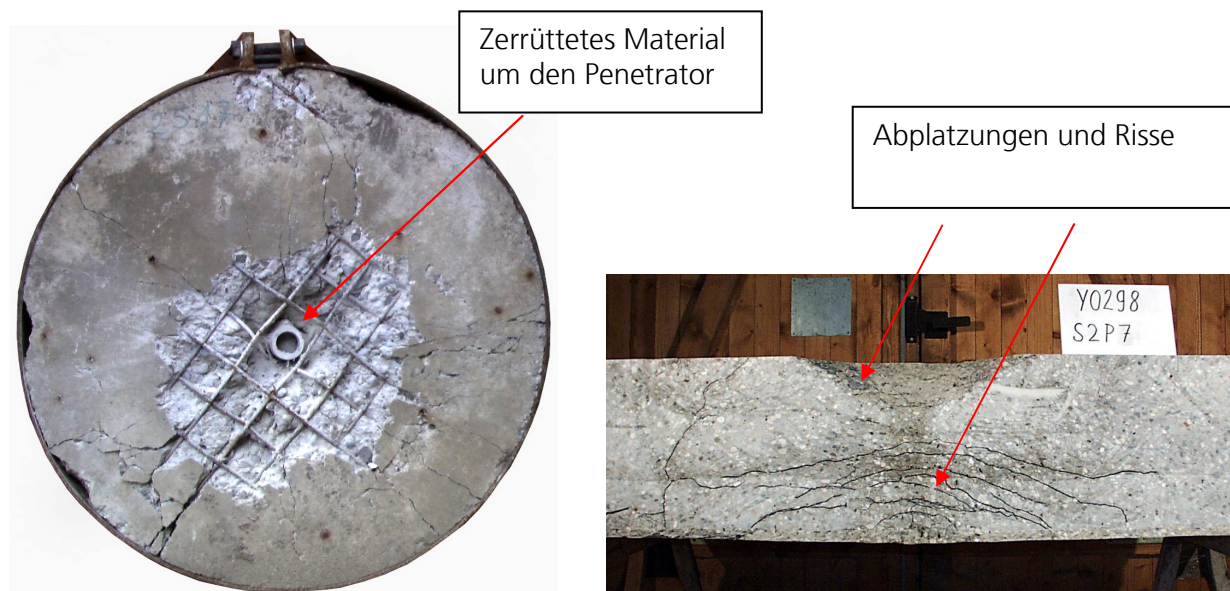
a) Beschuss eines bewehrten Betonkörpers (Vorderseite), b) mittig durchgesägte Betonplatte nach Beanspruchung durch eine Kontaktladung aus LANDMANN [71]
